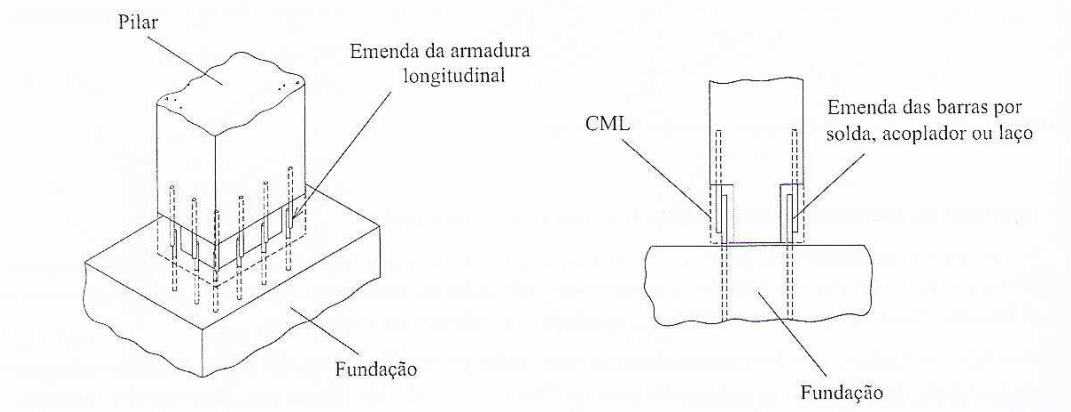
Ligação pilar x fundação emenda da armadura e concretagem posterior
